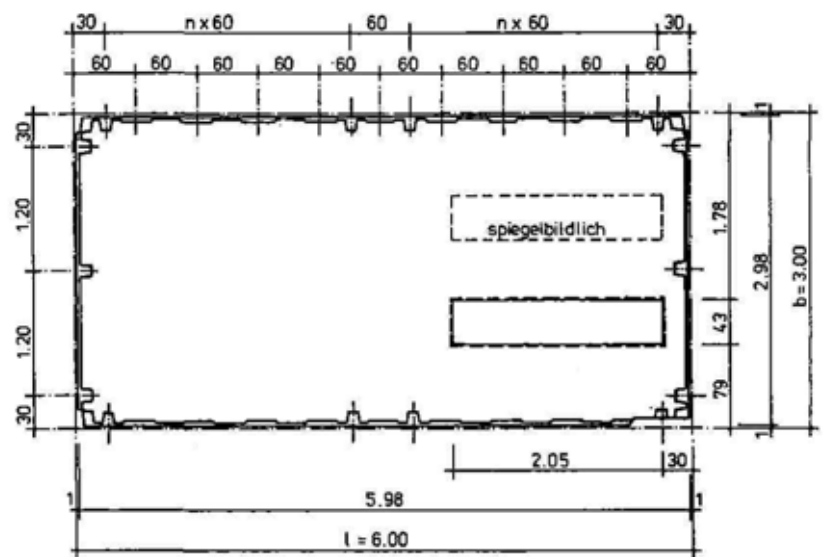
Deckenelement mit Öffnung für Installation Draufsicht
